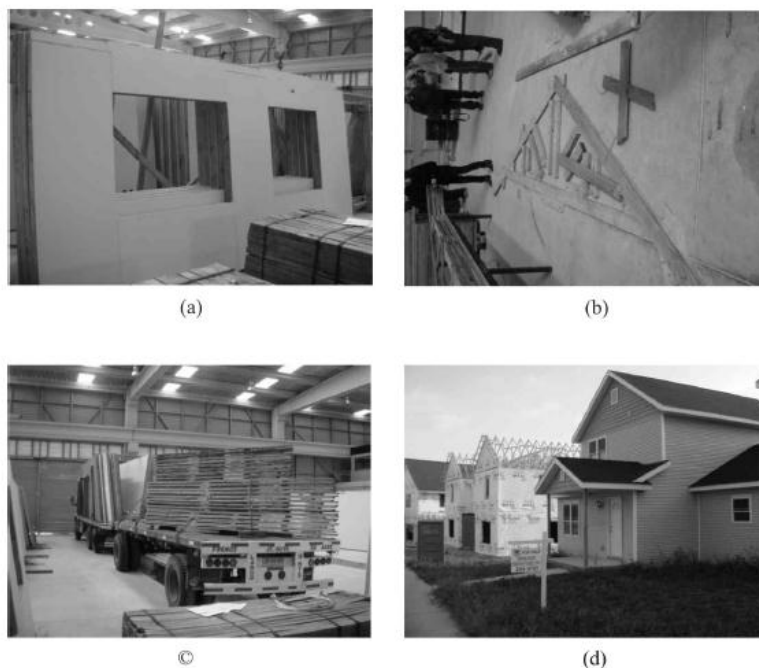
Fabricação industrial: (a) Painéis de parede (b) Trelças de cobertura; (c) Transporte indústria/obra; (d) Casa pronta.
